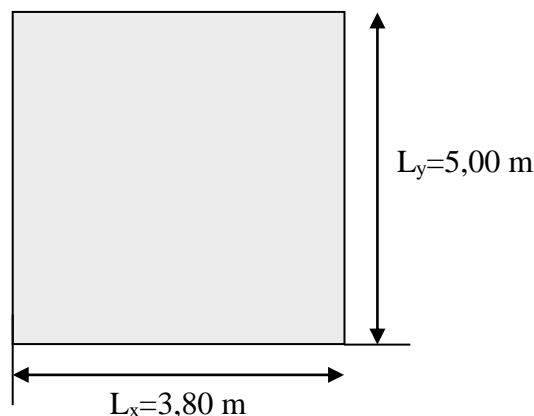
Les panneaux des fondations (le panneau le plus sollicité).
